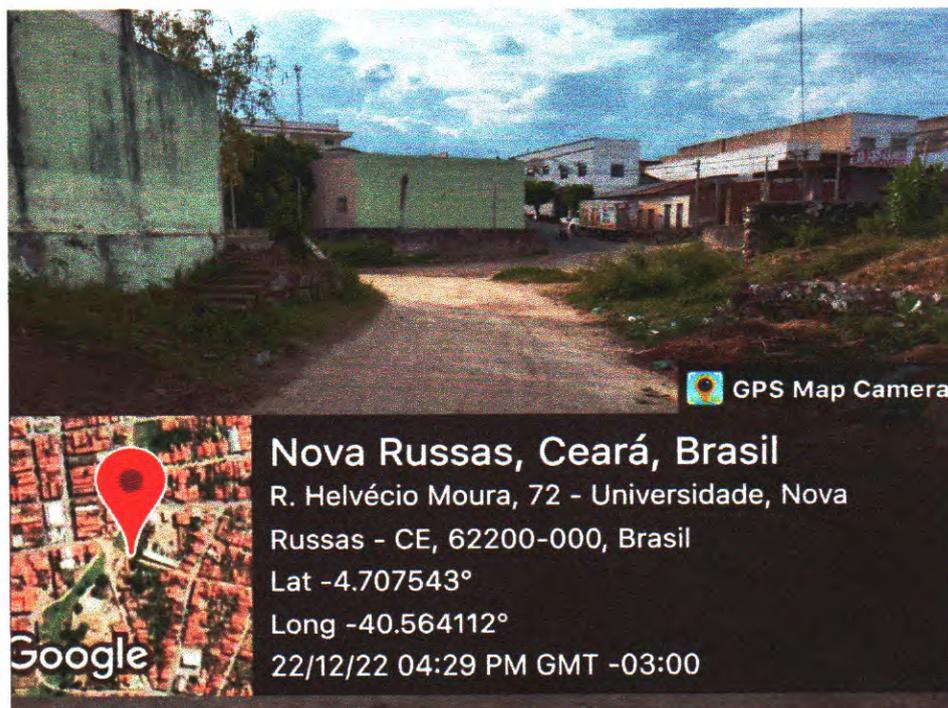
Vista do acesso à ponte pela Rua Helvécio Moura.
